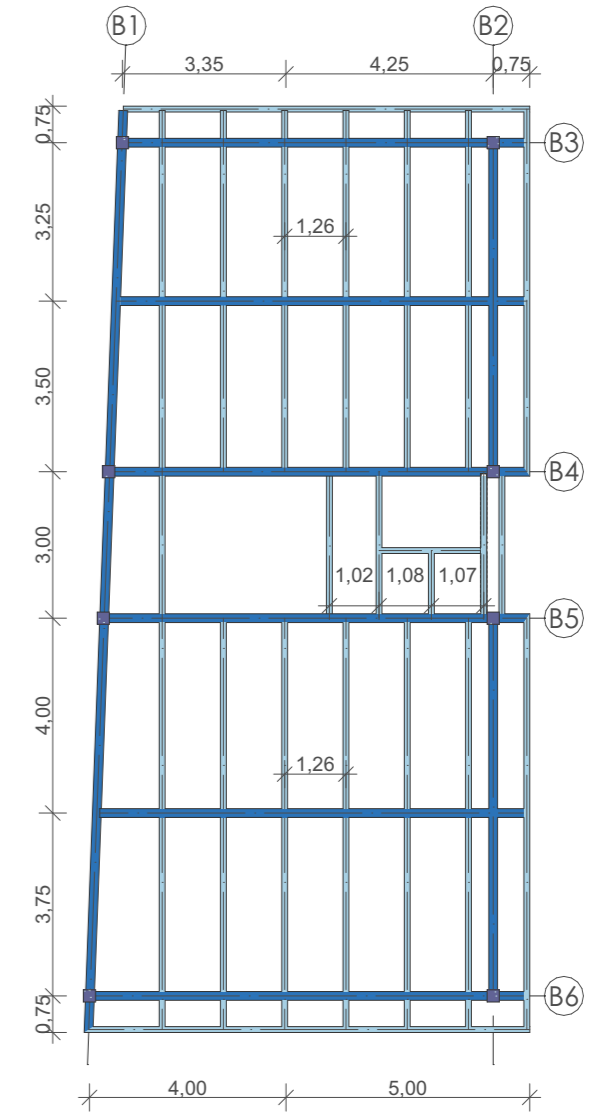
Planta de estructura del Bloque B Elaboración propia (2026). Escala 1:200
